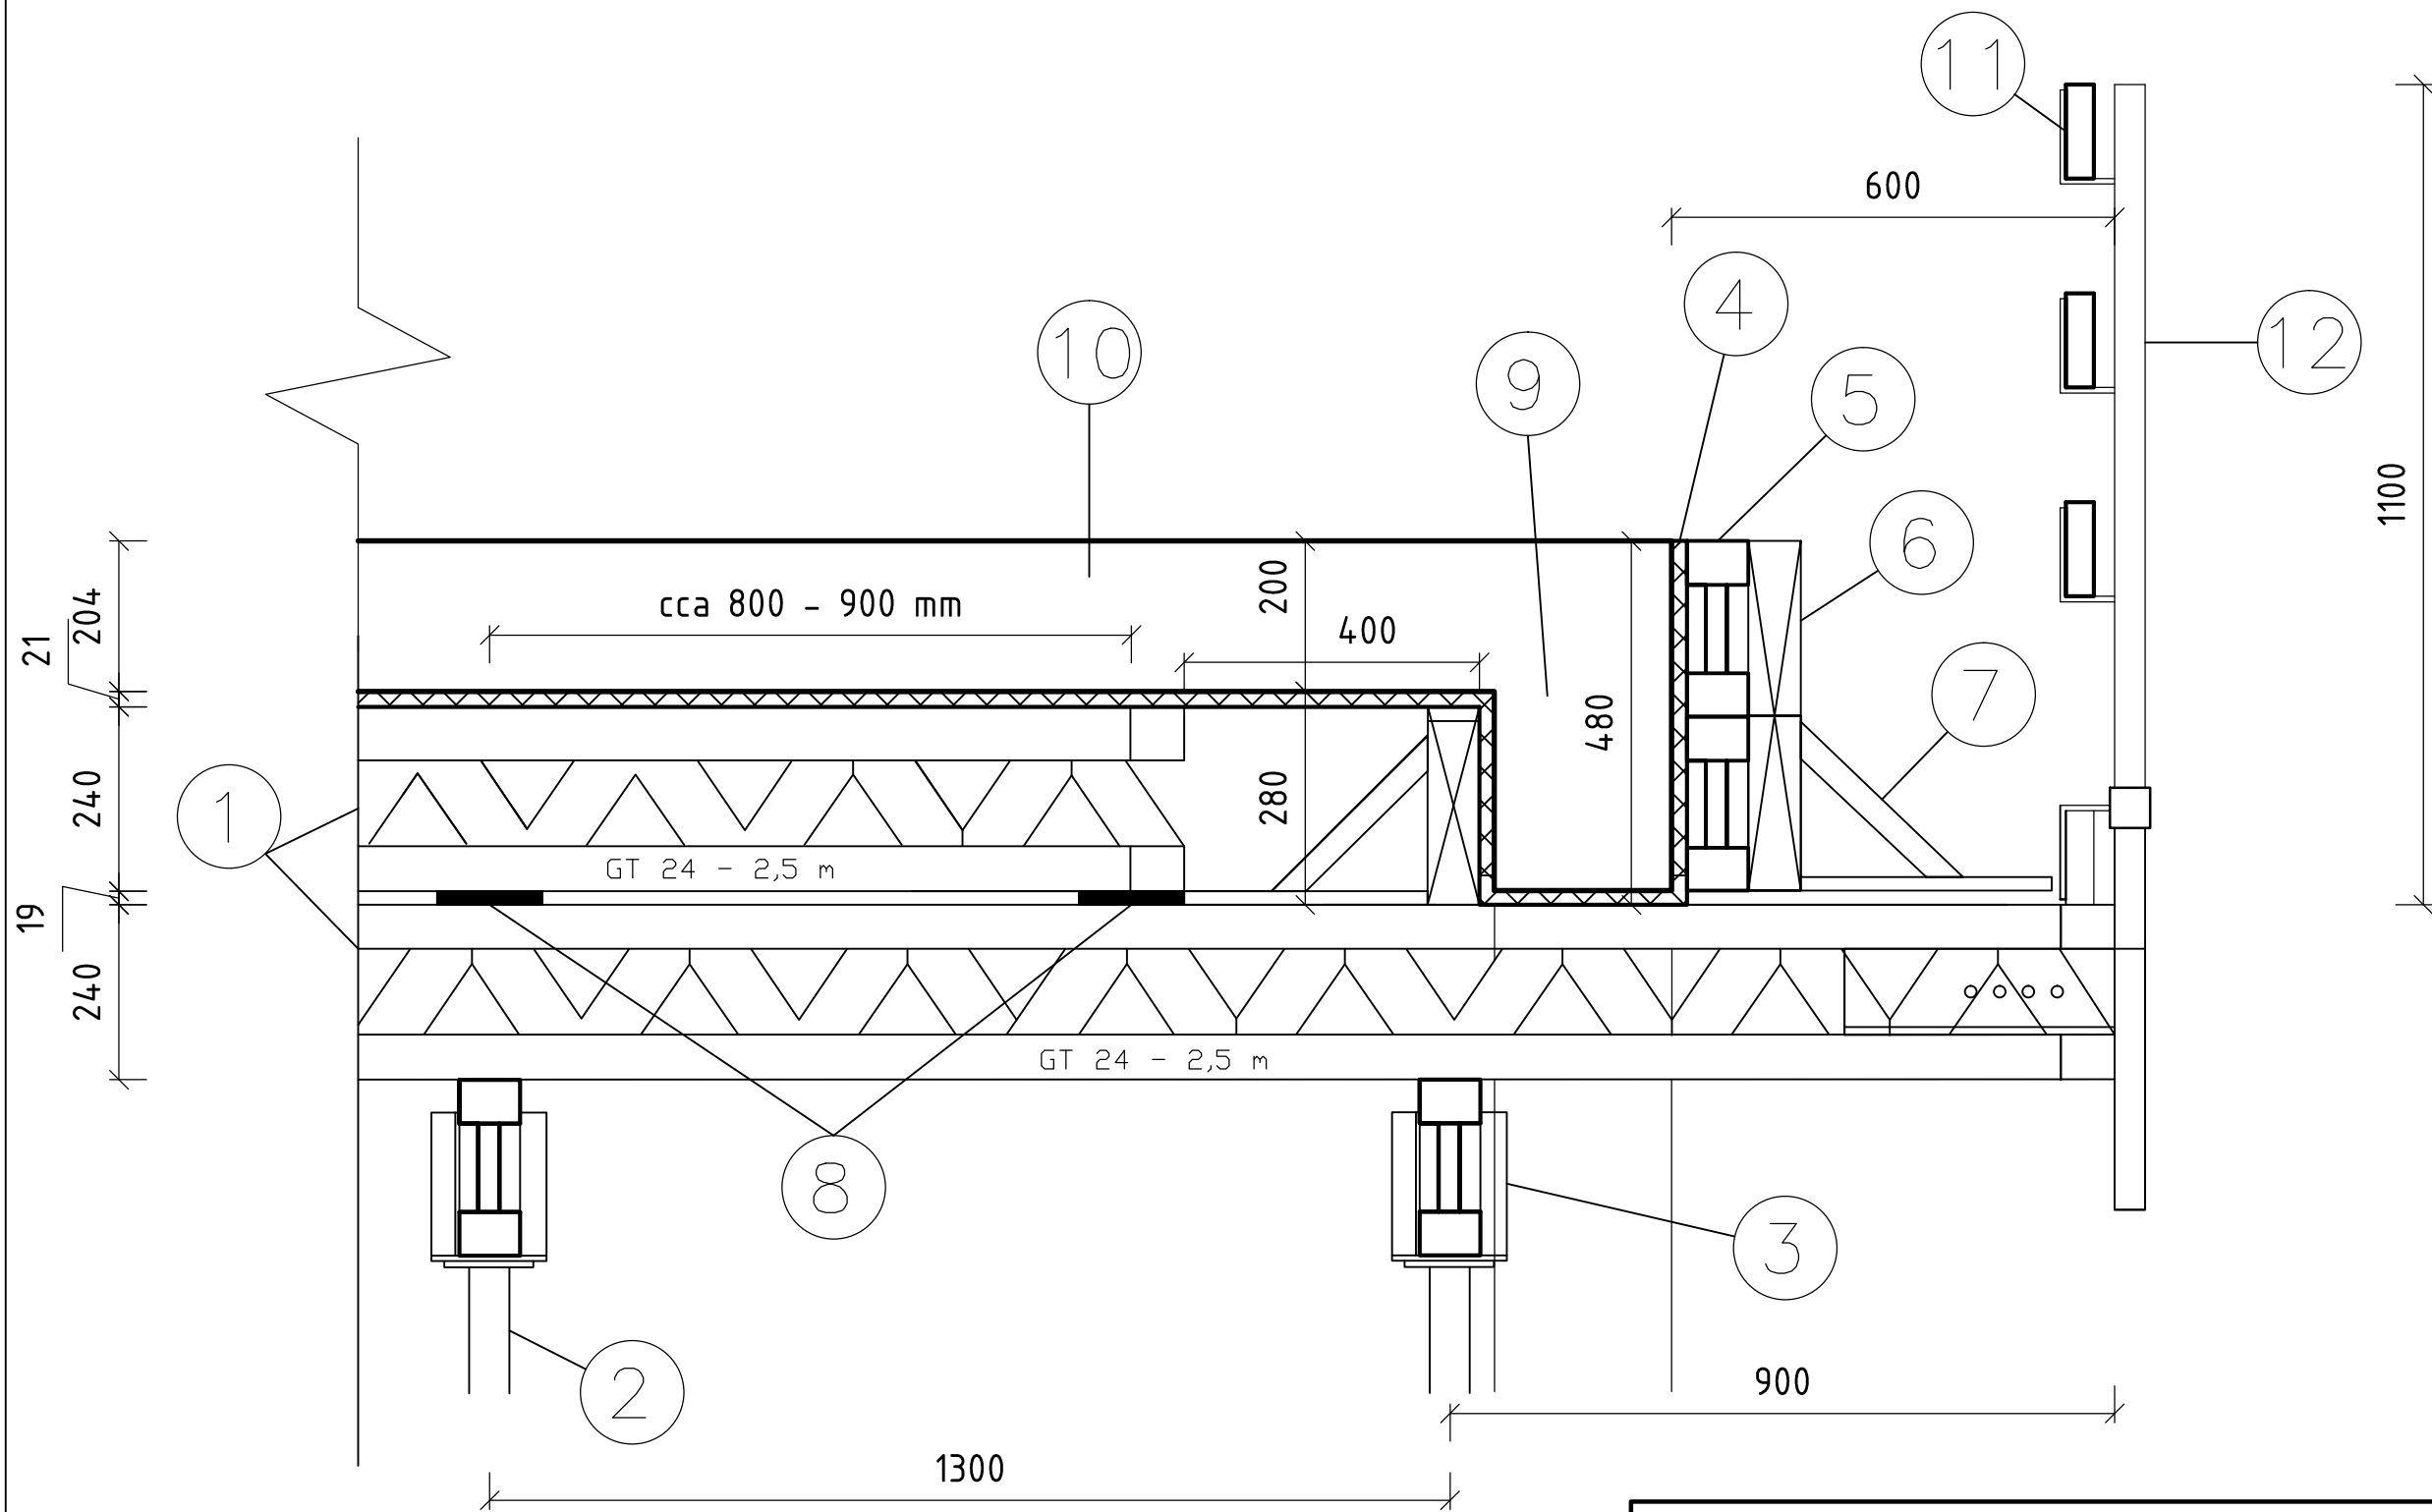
# DETAIL BEDNĚNÍ ŽB STROPNÍ KONSTRUKCE
